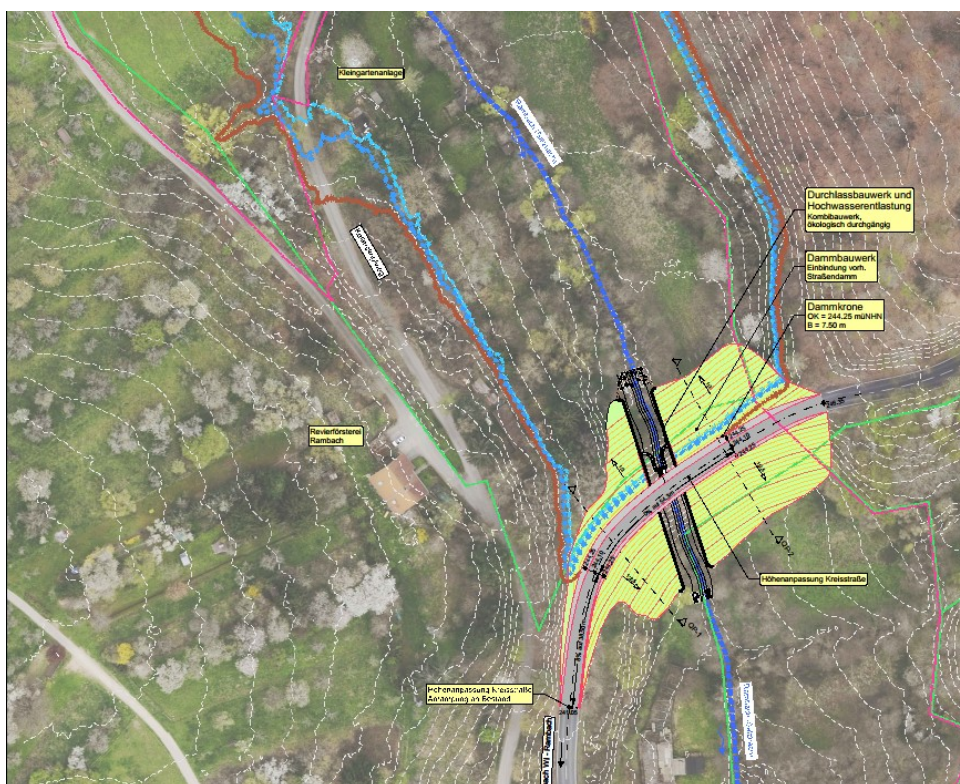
Lageplan [Quelle: BGS Wasserwirtschaft GmbH]
